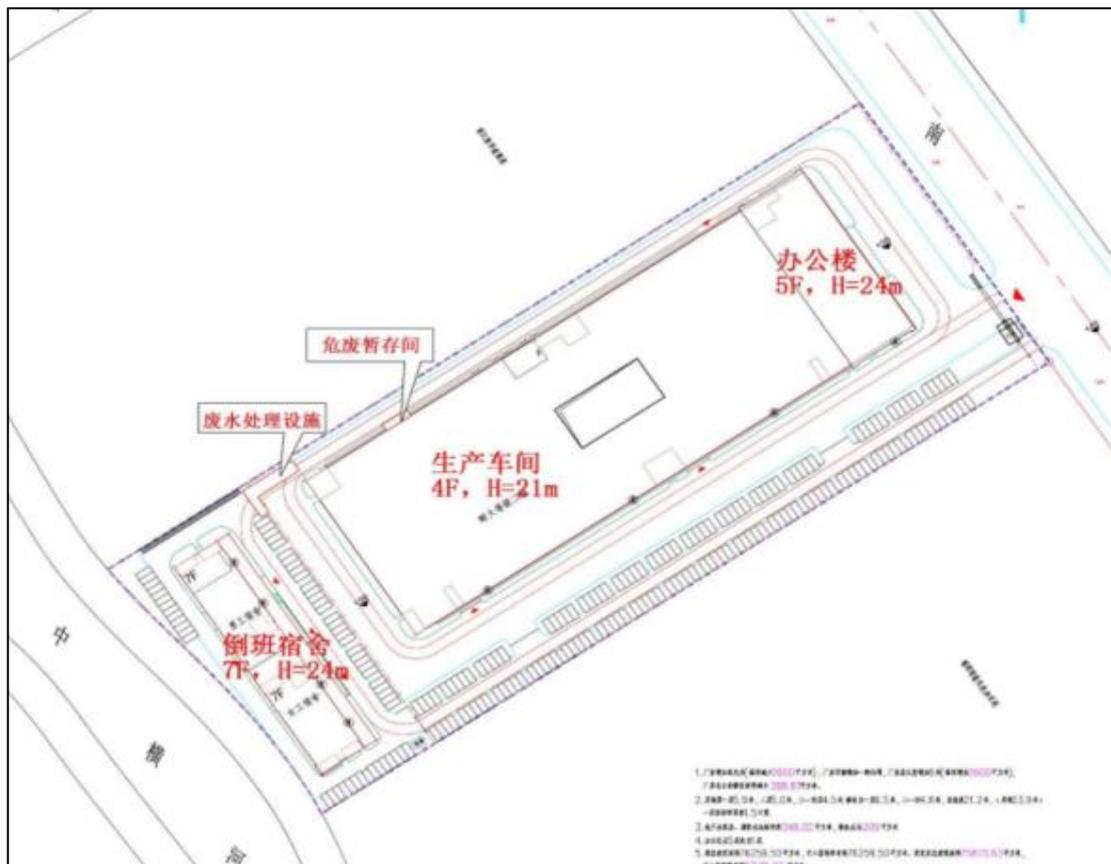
浙江锦佳汽车零部件有限公司厂区平面布置图
